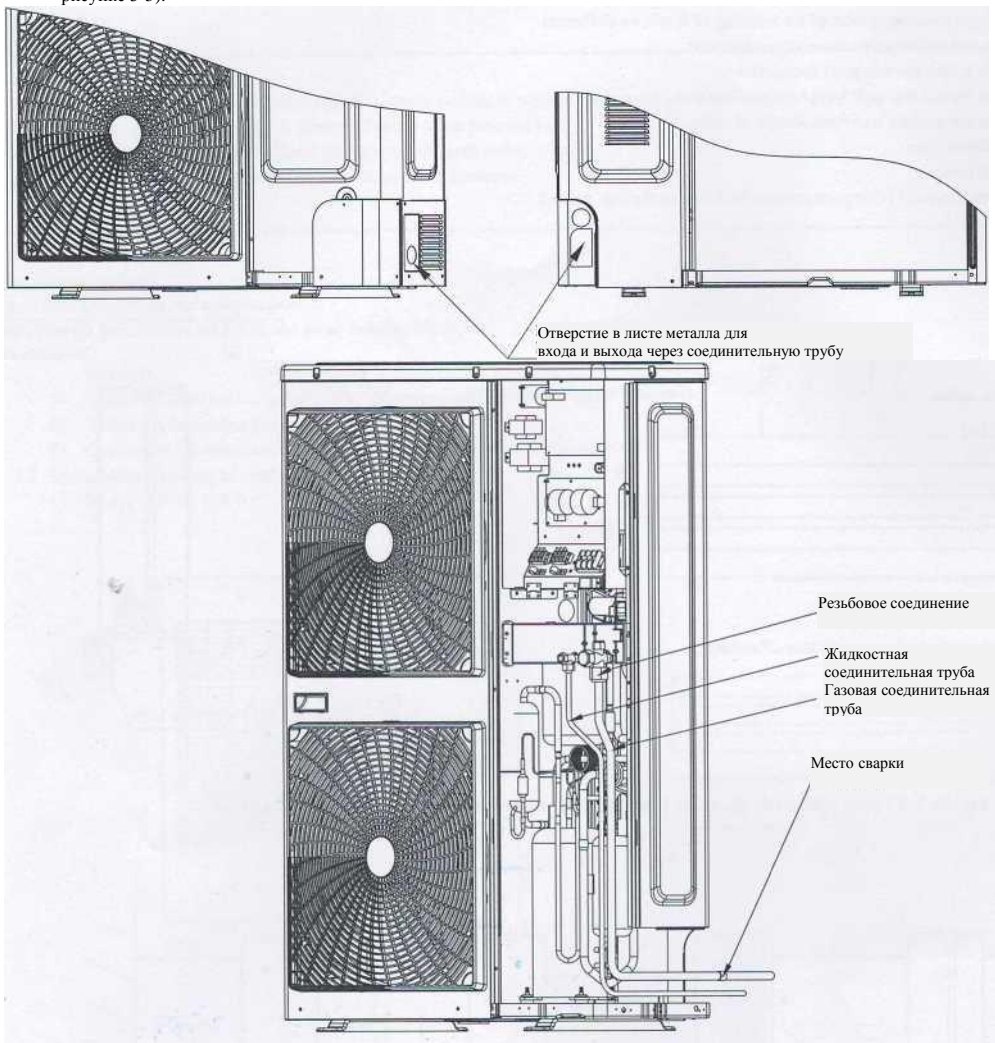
Схематический эскиз подсоединения труб наружного блока
